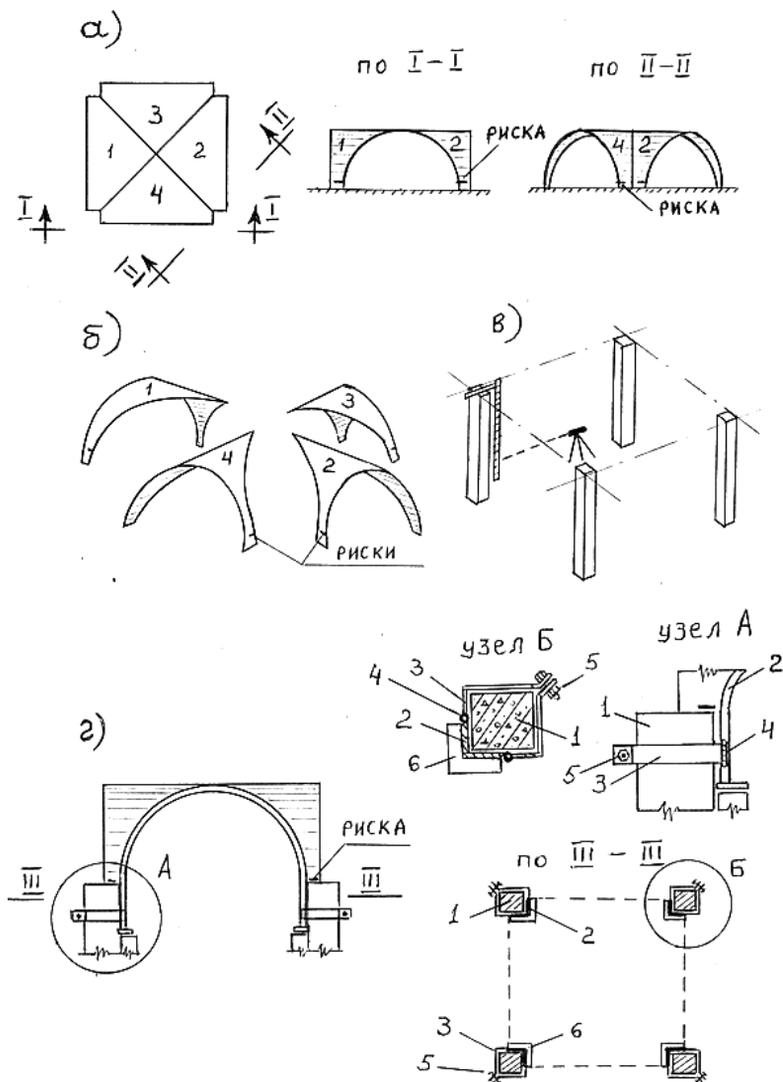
Технология возведения крестового свода по сборным ж/б колоннам: 1 – ж/б колонна; 2 – секторное кружало; 3 – хомут – затяжка; 4 – шарнир; 5 – болт; 6 – опора под секторное кружало.
